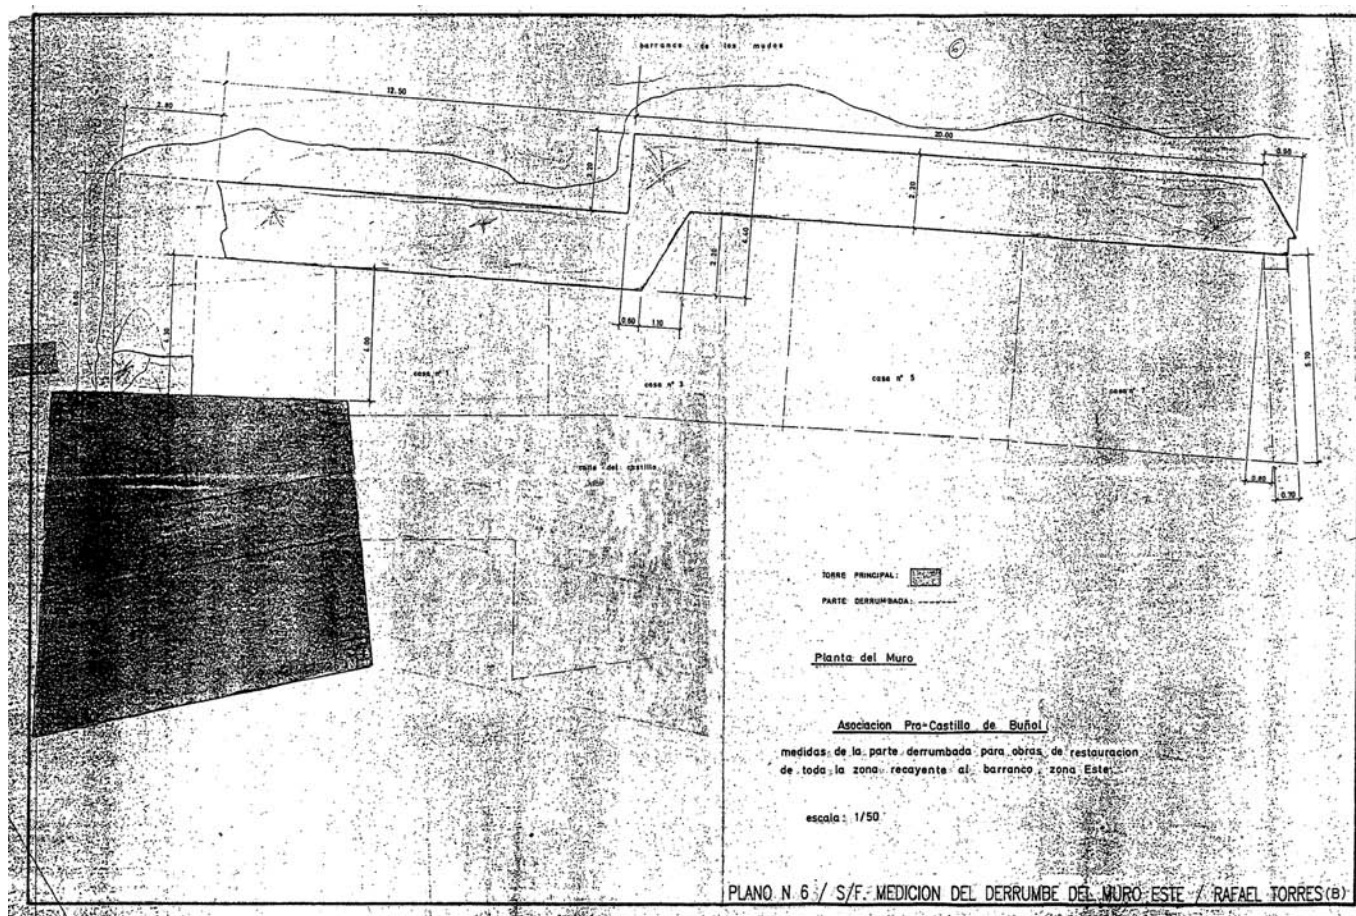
Medición del Derrumbe del Muro Este. Rafael Tomás. Planta
